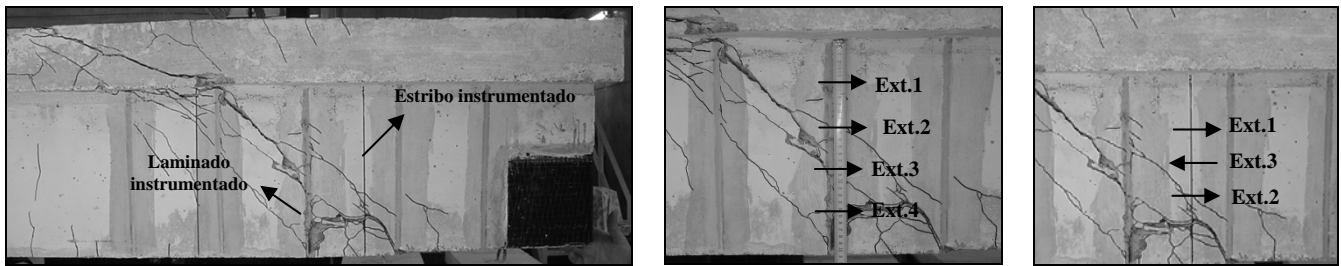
Localização dos extensómetros no laminado e estribo instrumentados da viga 2S-5LV-A.
